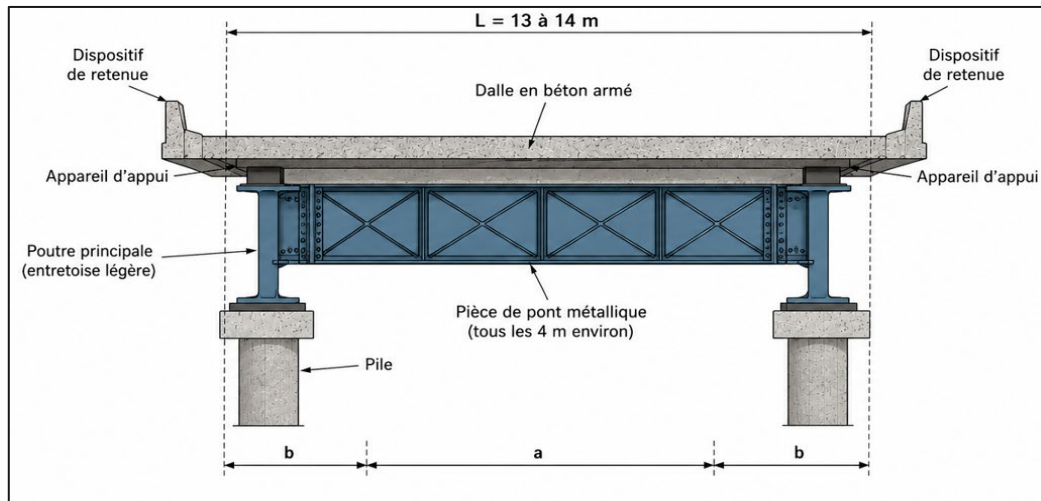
Coupe transversale d'un tablier bipoutre.
